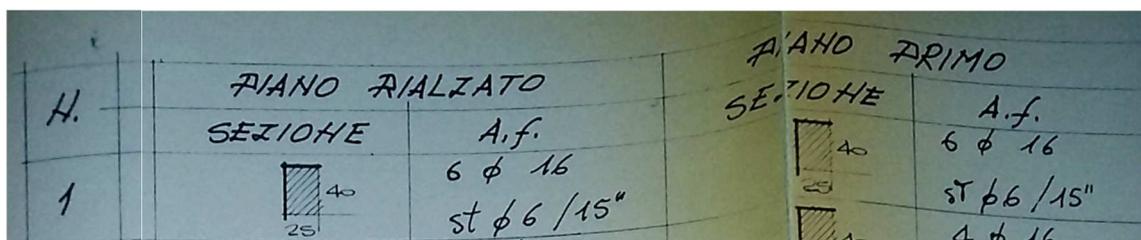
Armatura esistente P01, piano rialzato e piano primo.
